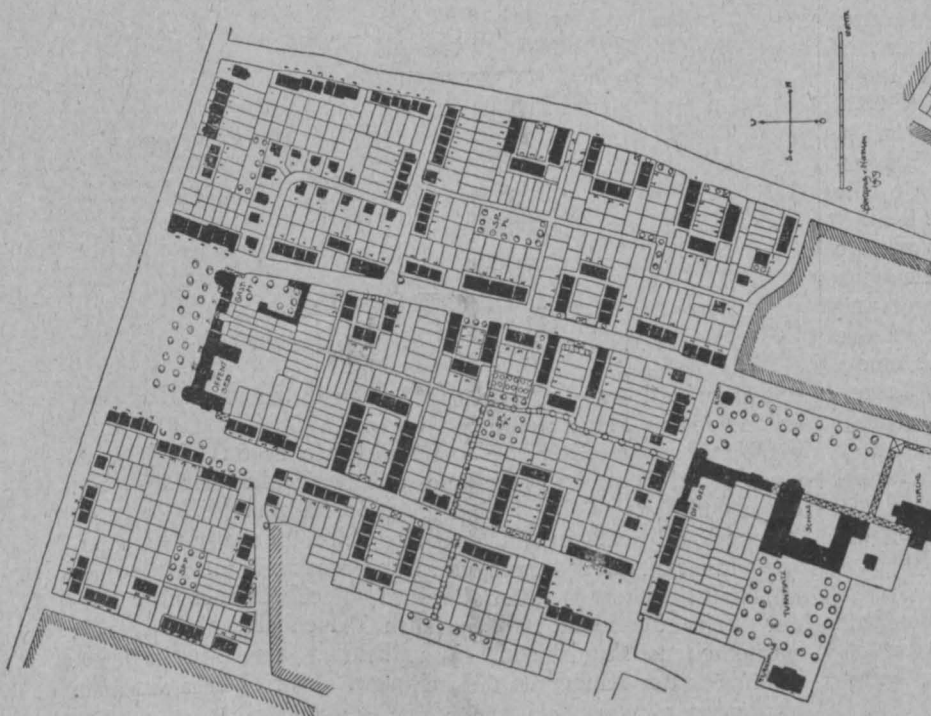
Gartenstadt München-Perlach, Detailplan der Siedlung „West“
